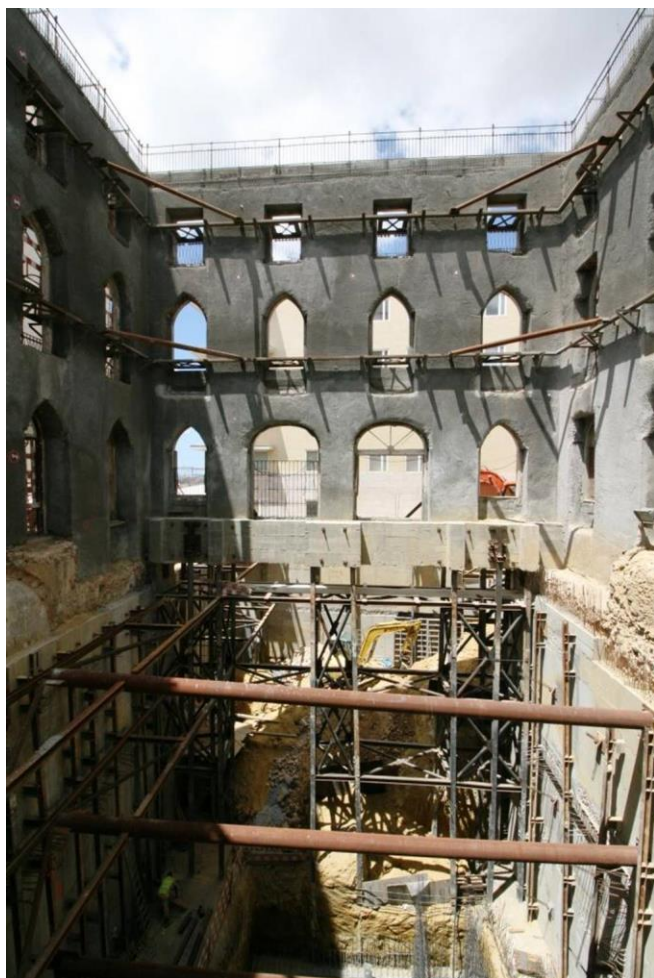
Estrutura de suspensão da fachada poente e estrutura de contenção periférica.
